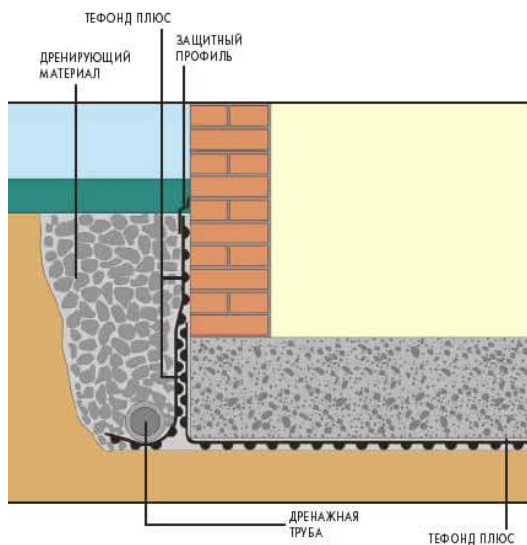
Фундаментная плита при отсутствии грунтовых вод
